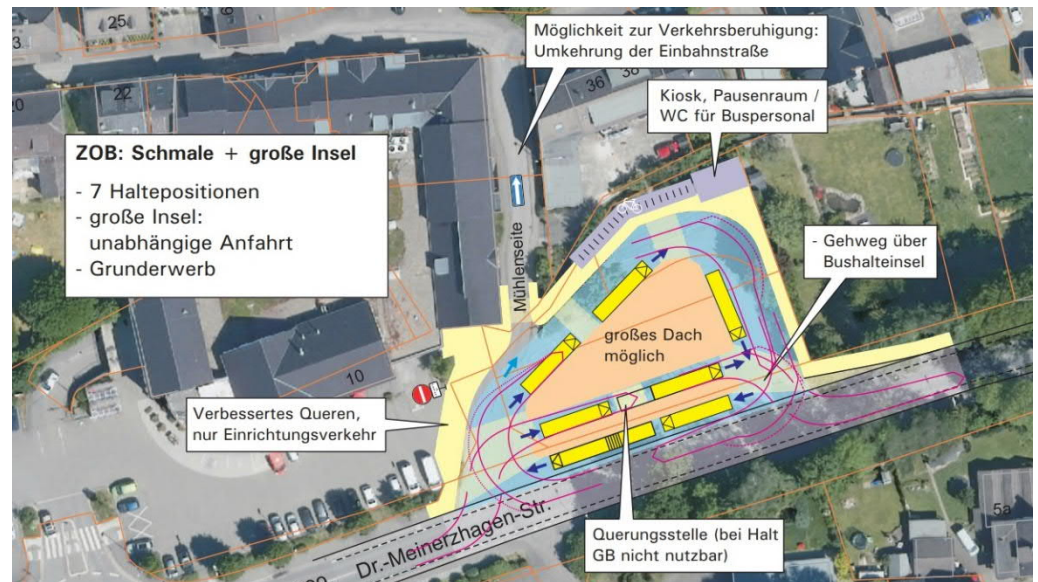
Vollvariante (Grunderwerb erforderlich)
